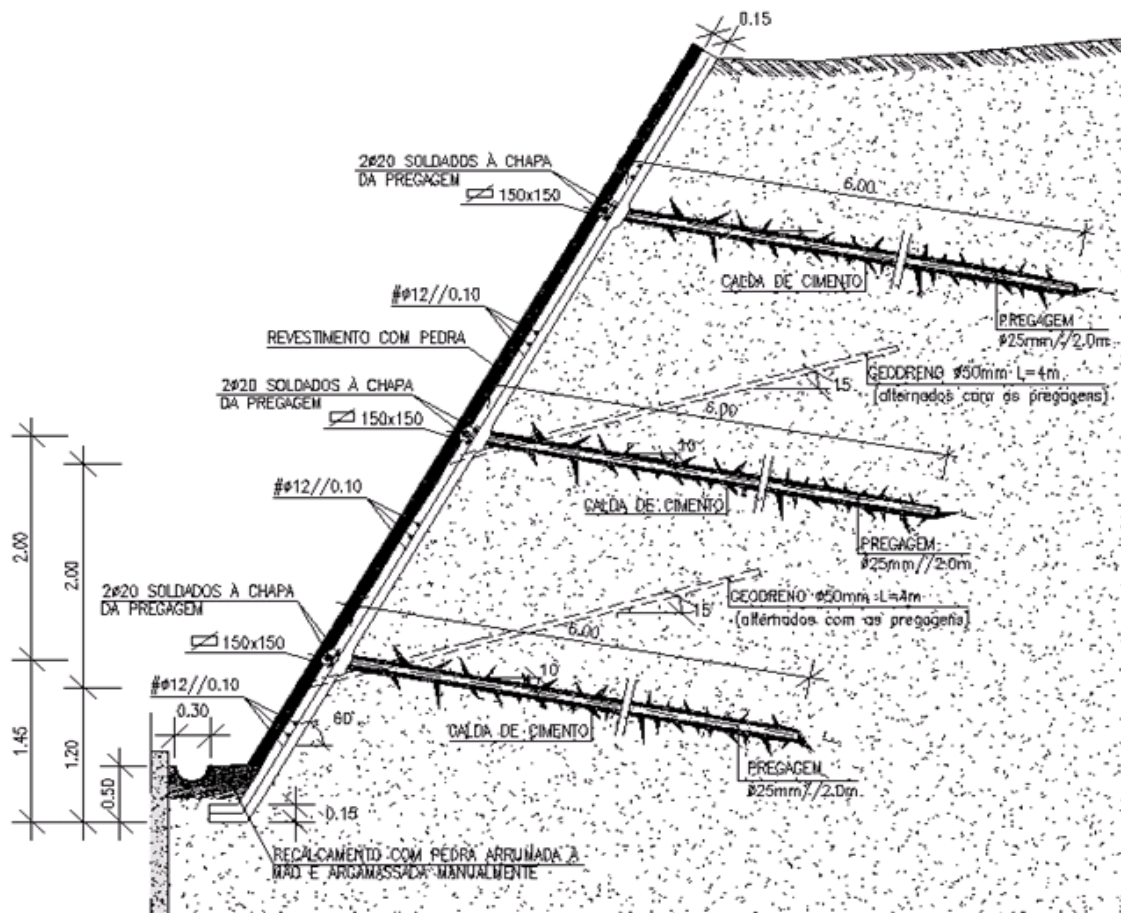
Paramento de betão projectado armado e pregado: dimensionamento e armaduras (GEG)
